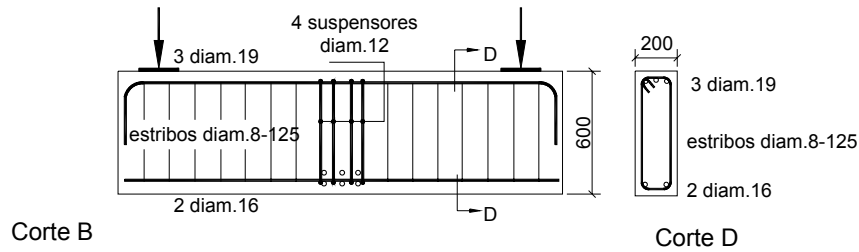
Vista en elevación y corte de la viga que transfiere la carga (Nodo A) (1 mm = 0,03937 in.)
